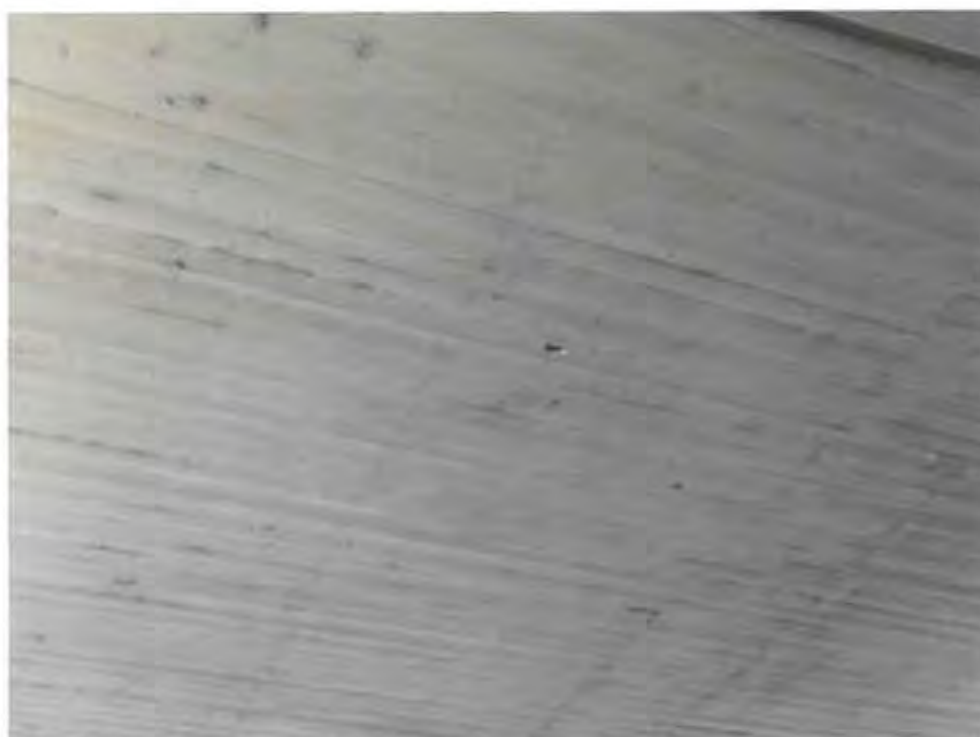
Deckenunterseite: Sichtbeton, Rissbildung
